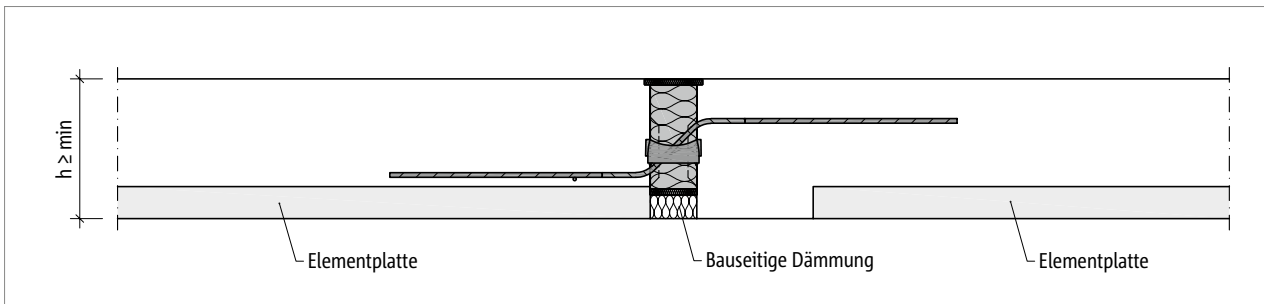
Schöck Isokorb® T Typ QL: Elementdecke mit aufgesetzten Schöck Isokorb®
